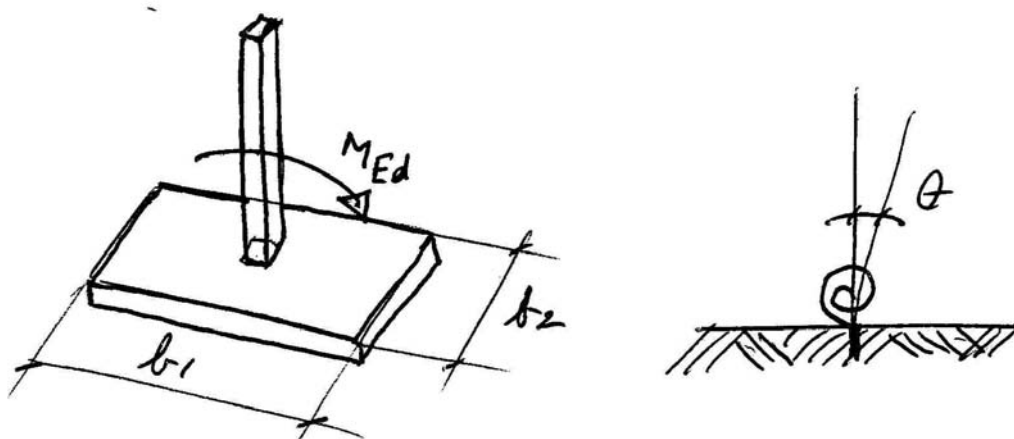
Modélisation d'une semelle isolée sur sol flexible.
